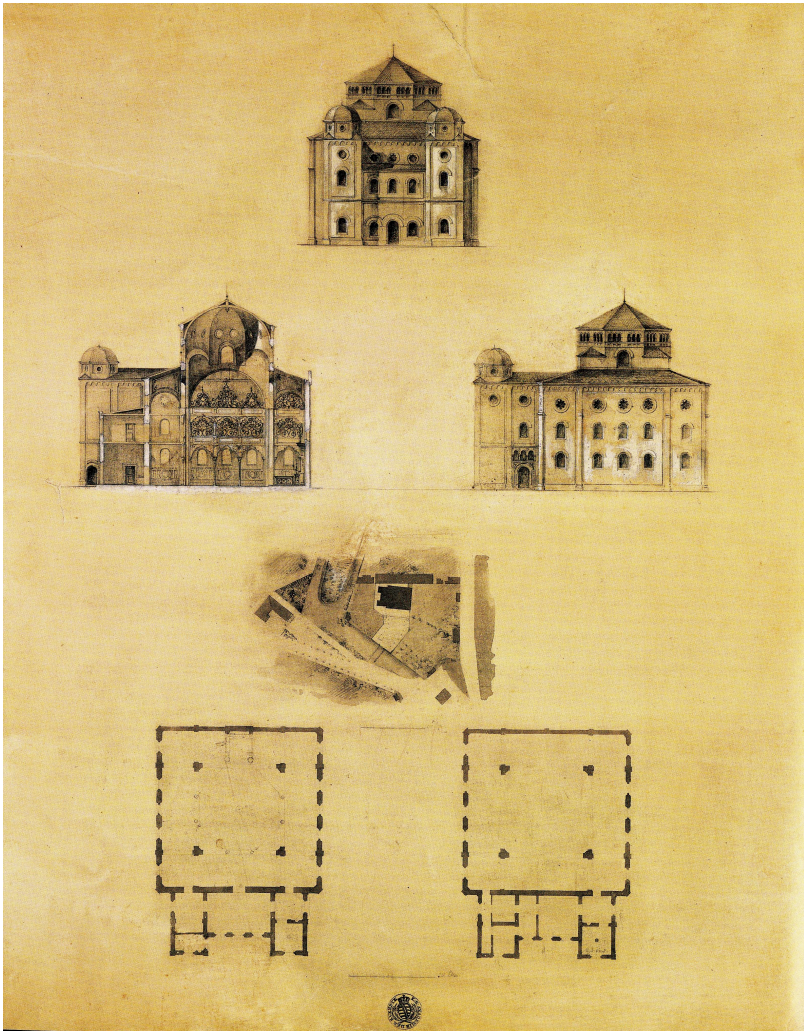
Gottfried Semper: Übersichtsblatt des zweiten Projekts der Synagoge in Dresden mit Lageplan, Ansicht Eingangsseite, Seitenansicht, Längsschnitt sowie zwei Grundrissen. April/Mai 1838, H. 53.8 cm, B. 44.4 cm. Bleistift laviert, weiss gehöht auf getöntem Papier. Standort: Archiv und Kustodie der Hochschule für Bildende Künste, Dresden
